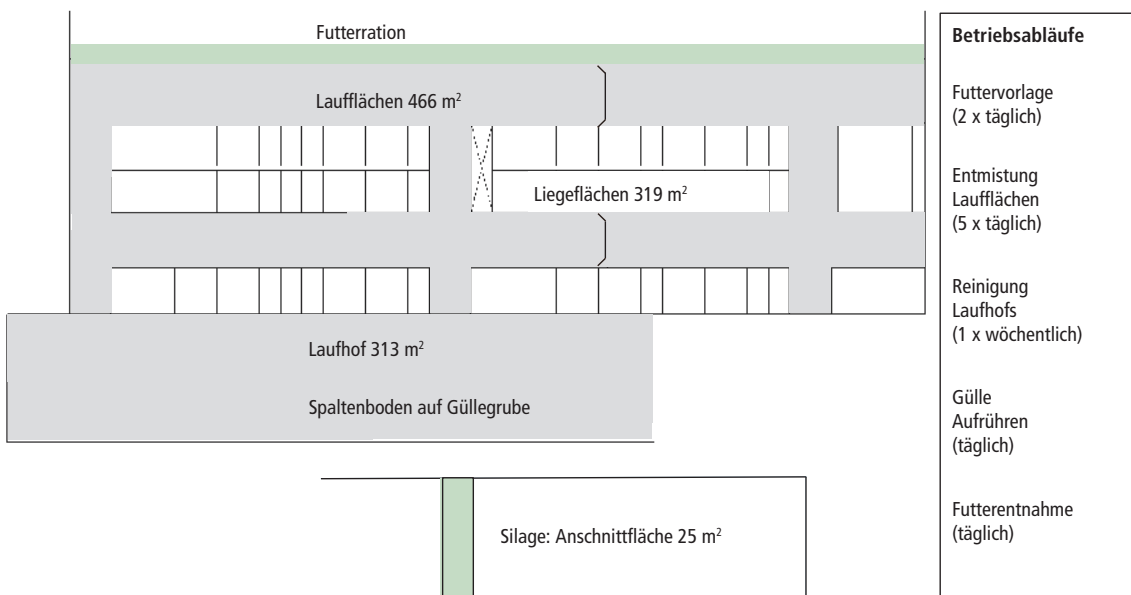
| Grundriss des Milchviehbetriebes mit Anlageteilen und Einzelquellen sowie Angaben zu Betriebsabläufen.
